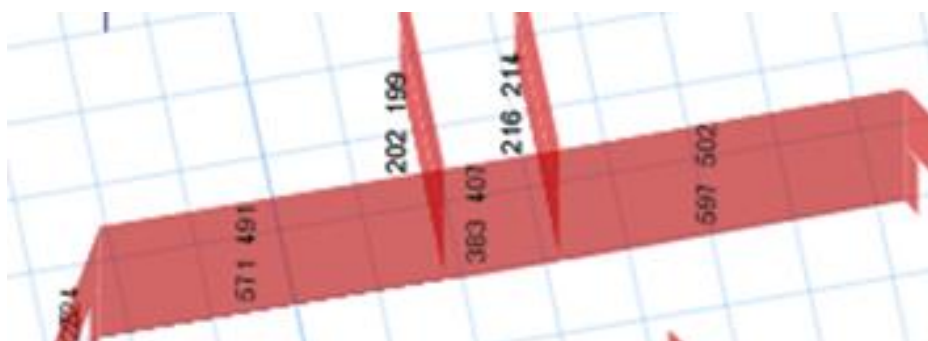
Фрагмент армирования стены (ДЖМ) на отм. 0.000 м до отм. 4.95 м по оси Г/б (площадь полной арматуры)
